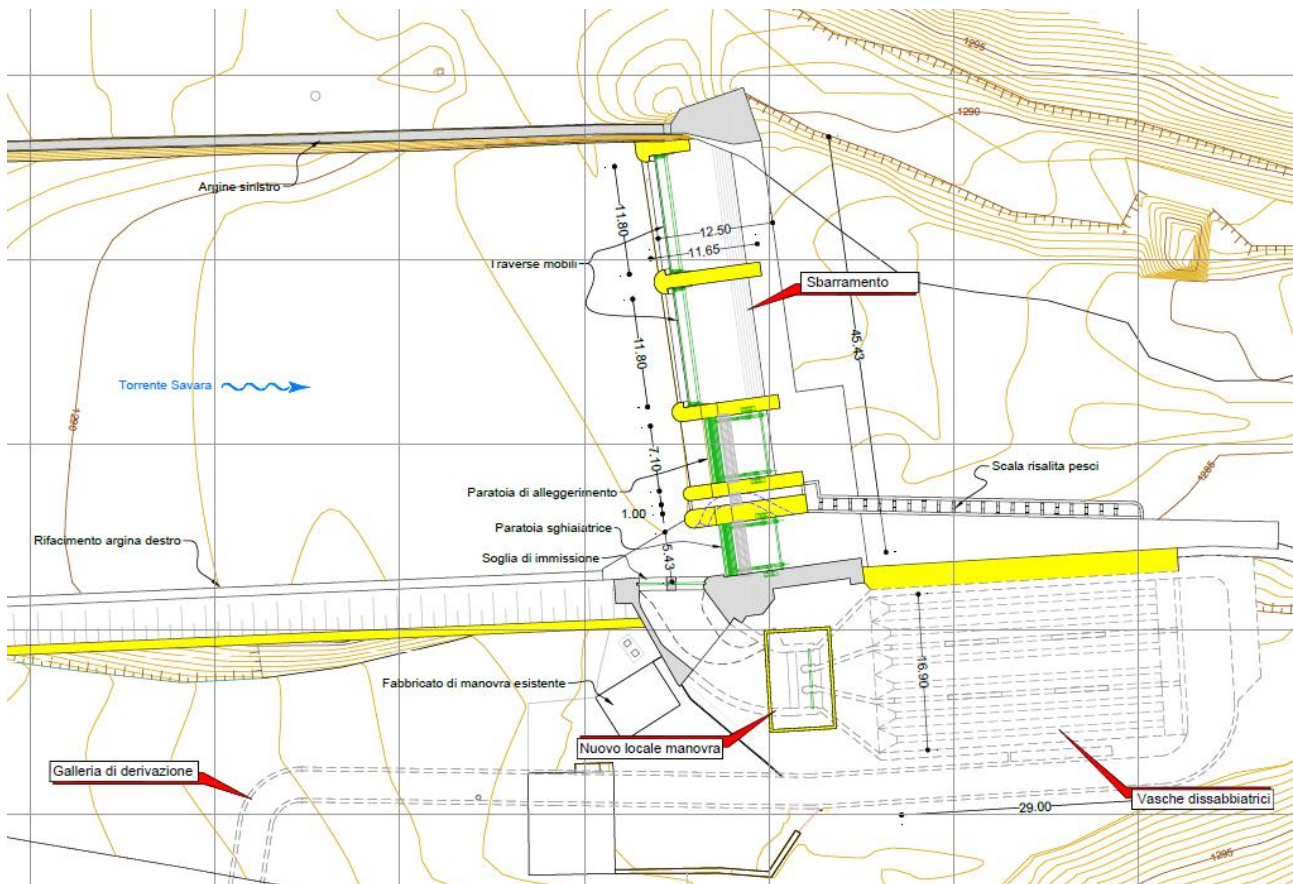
Pianta di Progetto opera di presa Fenille
